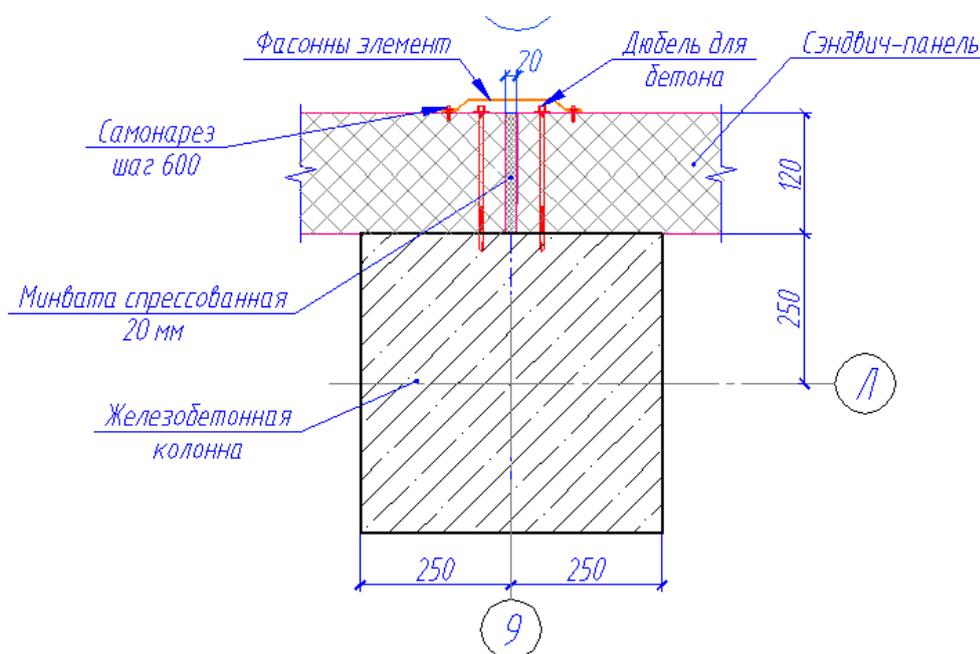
Узел крепления панели к колонне железобетонной каркаса
